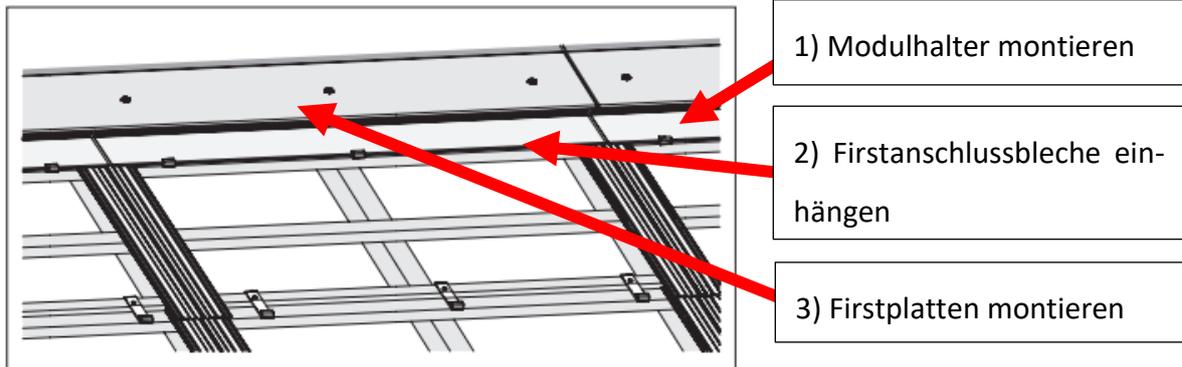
Firstanschlussblech (Quelle: Swisspearl Details Sunskin Roof Lap)
